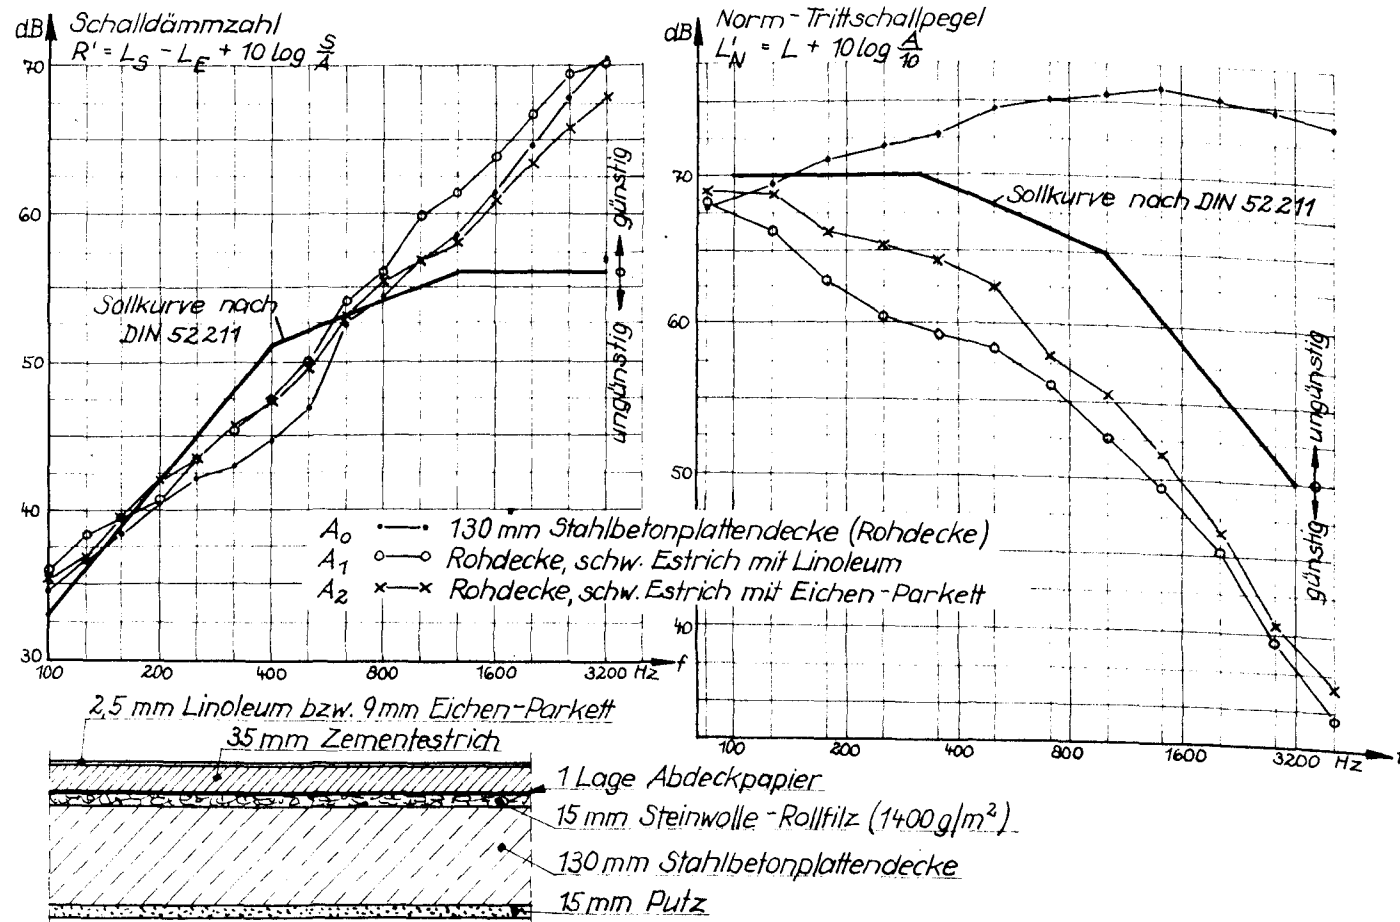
Schalldämmzahlen und Norm-Trittschallpegel einer Stahlbetonplattendecke ohne Fußboden und mit zwei verschiedenen Fußböden sowie Deckenquerschnitt.
